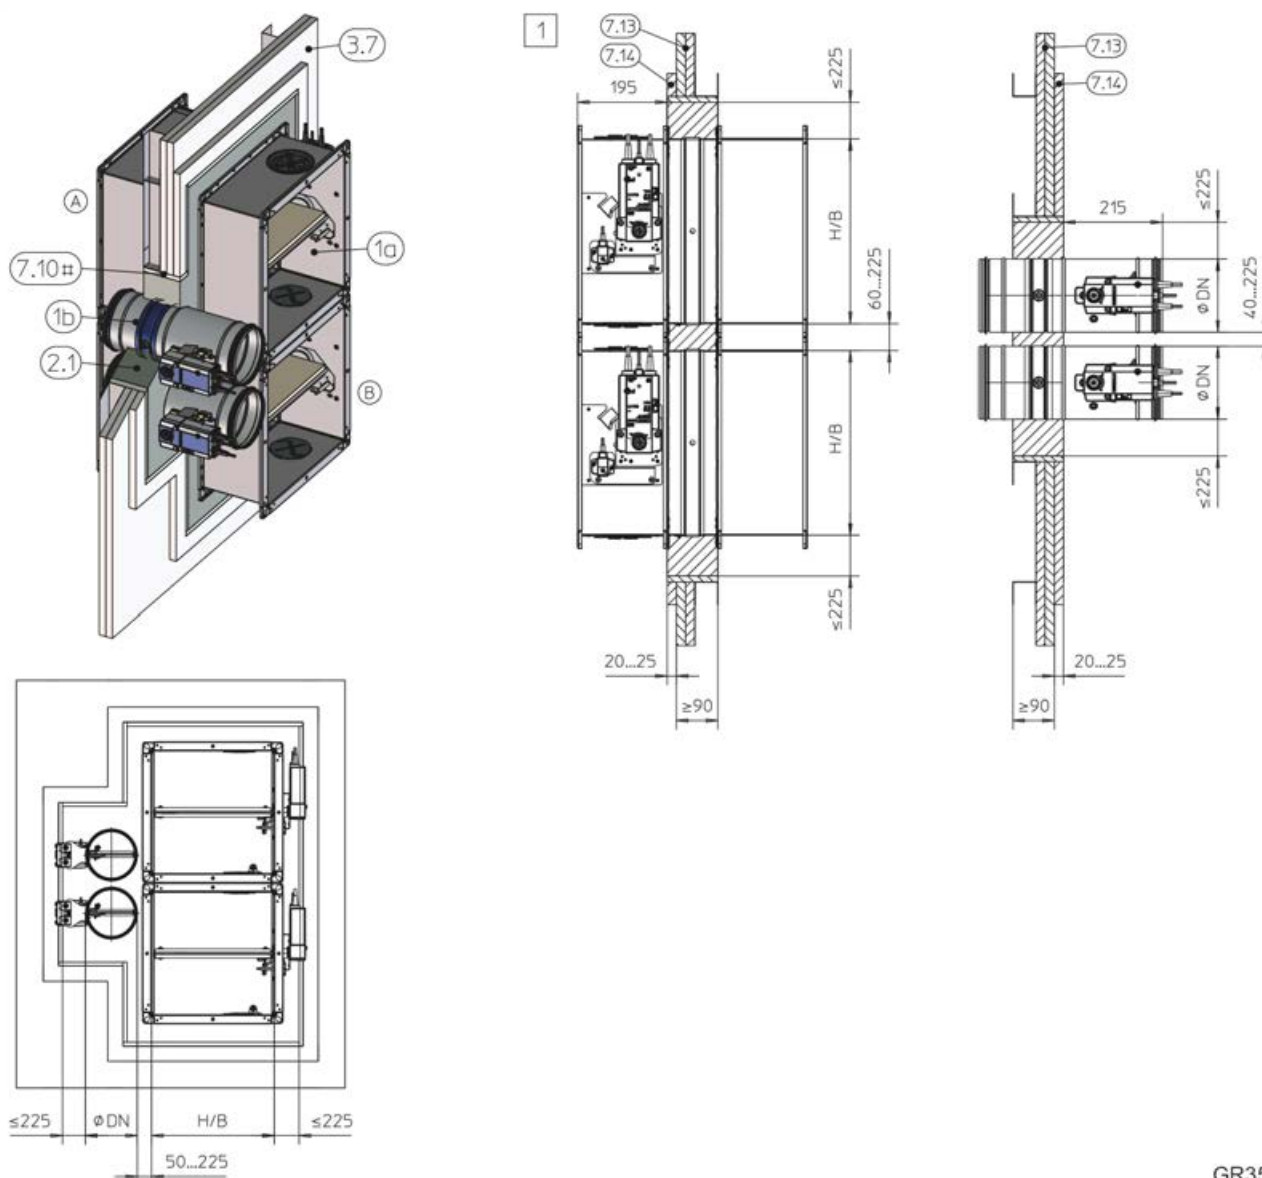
Vådindbygning i en skaktvæg, flange til flange, illustrationen viser side-for-side-installation (gælder også for installation af spjæld oven på hinanden)
